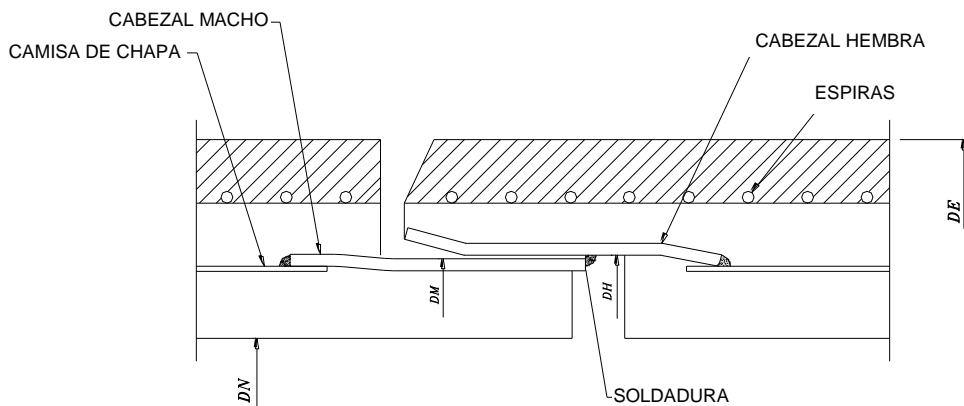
Tubería de hormigón postesado "de camisa embebida".
